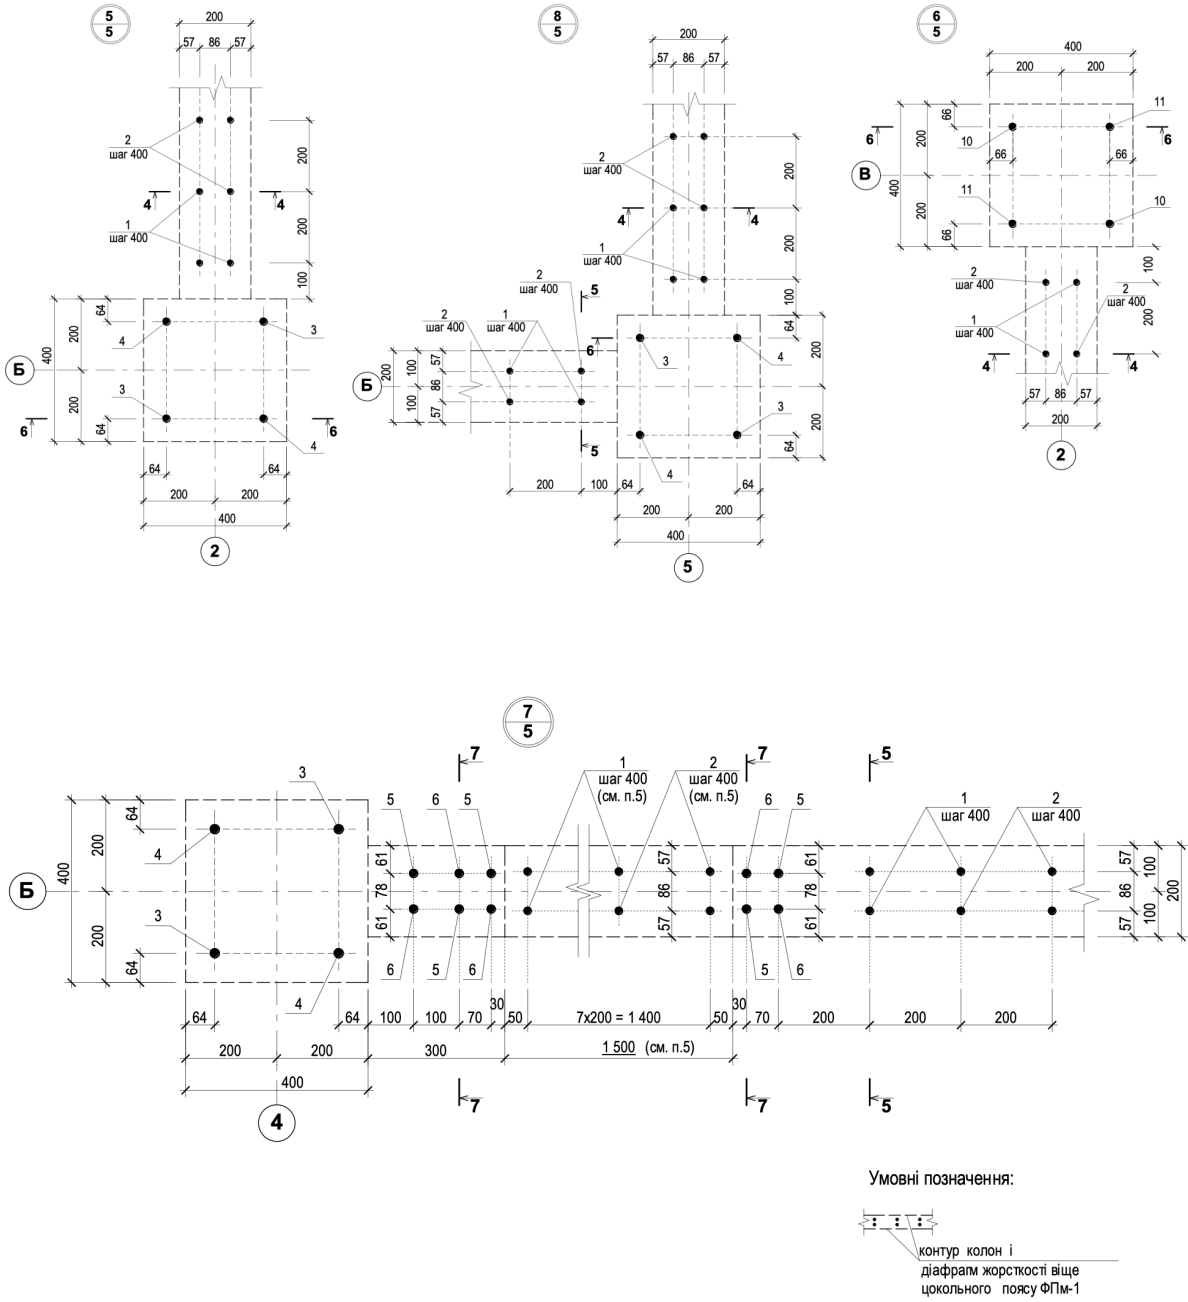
Додаток до схеми розташування фундаментів
